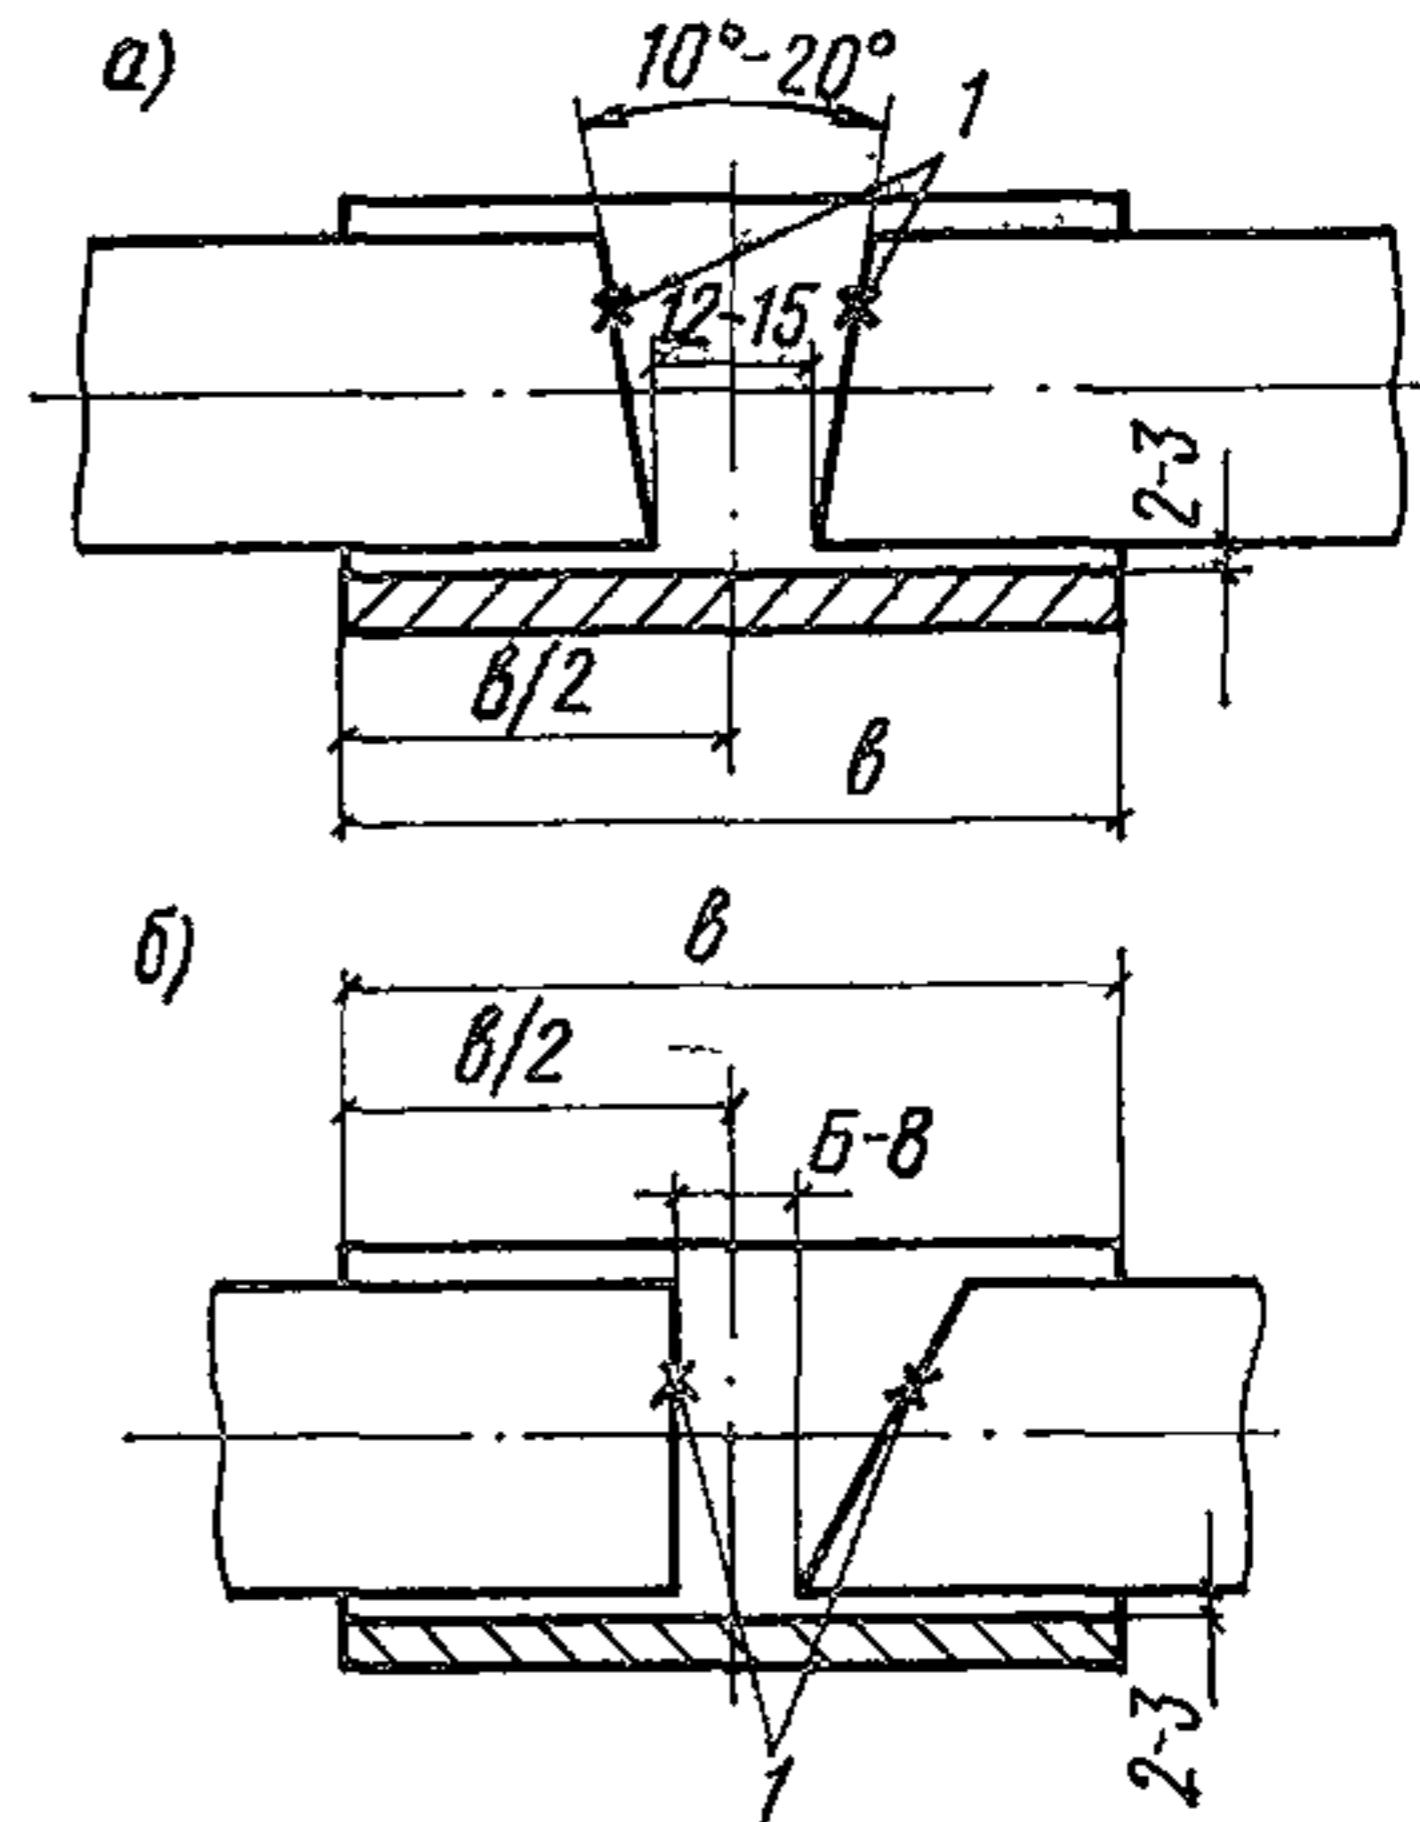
Схема сборки концов подлежащих сварке стержней
